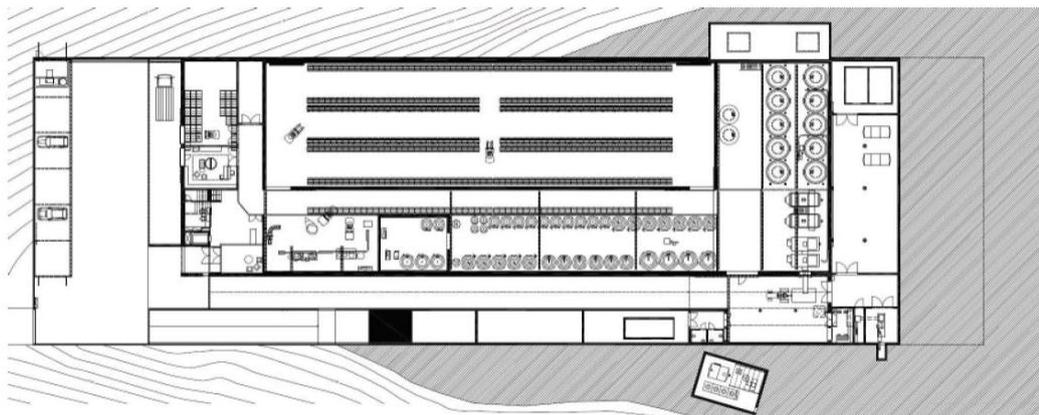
Adega Mayor – Planta do Piso 0²⁶
